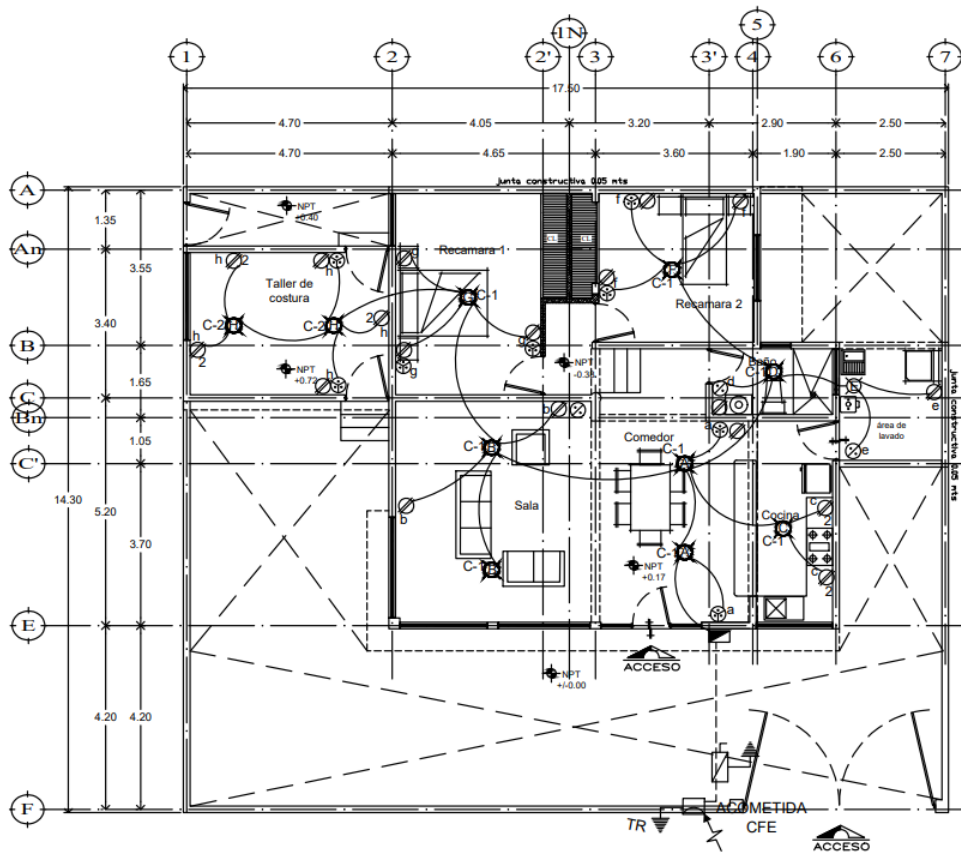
Propuesta de instalación eléctrica, caso Leticia Navarro Alfaro. Elaboración propia.
